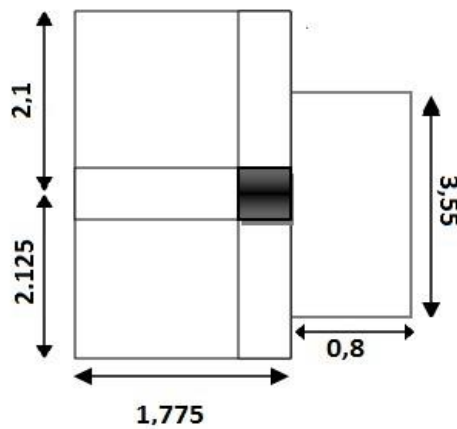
Surface revenant au poteau de rive (poteau F3)
